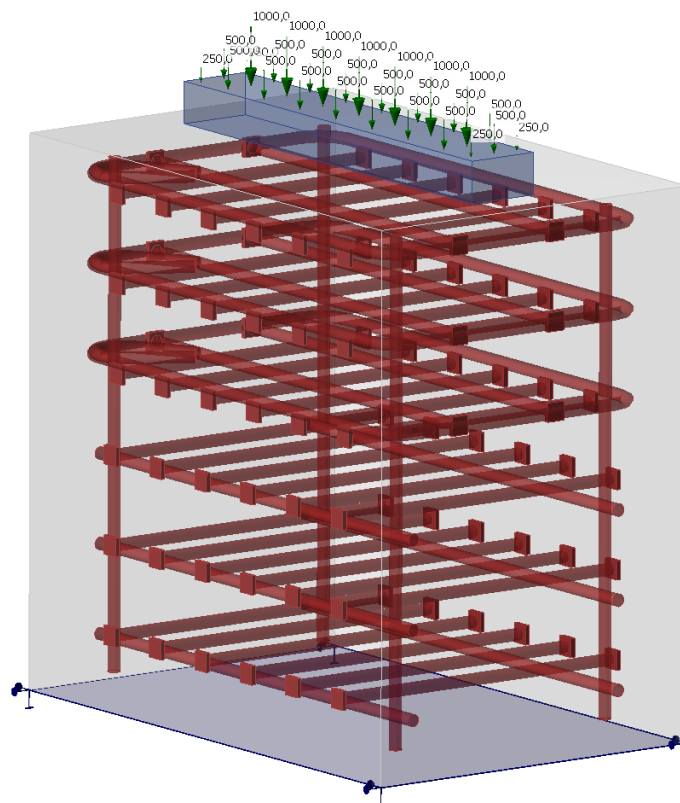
Geometría y configuración de carga del espécimen C1 en el modelo de IDEA StatiCa Detail. Cargas en kN.
